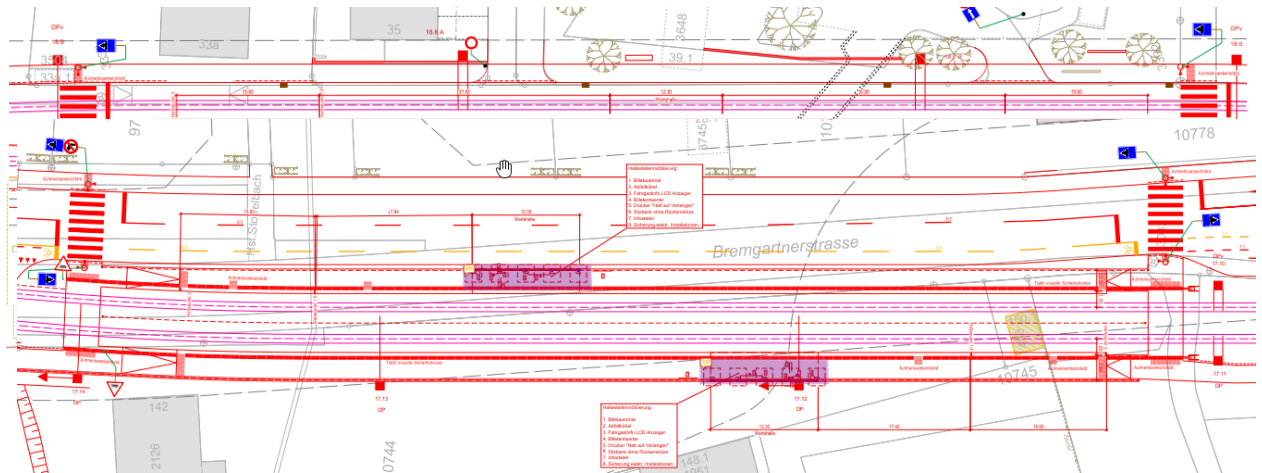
Grundriss Dietikon Stoffelbach
